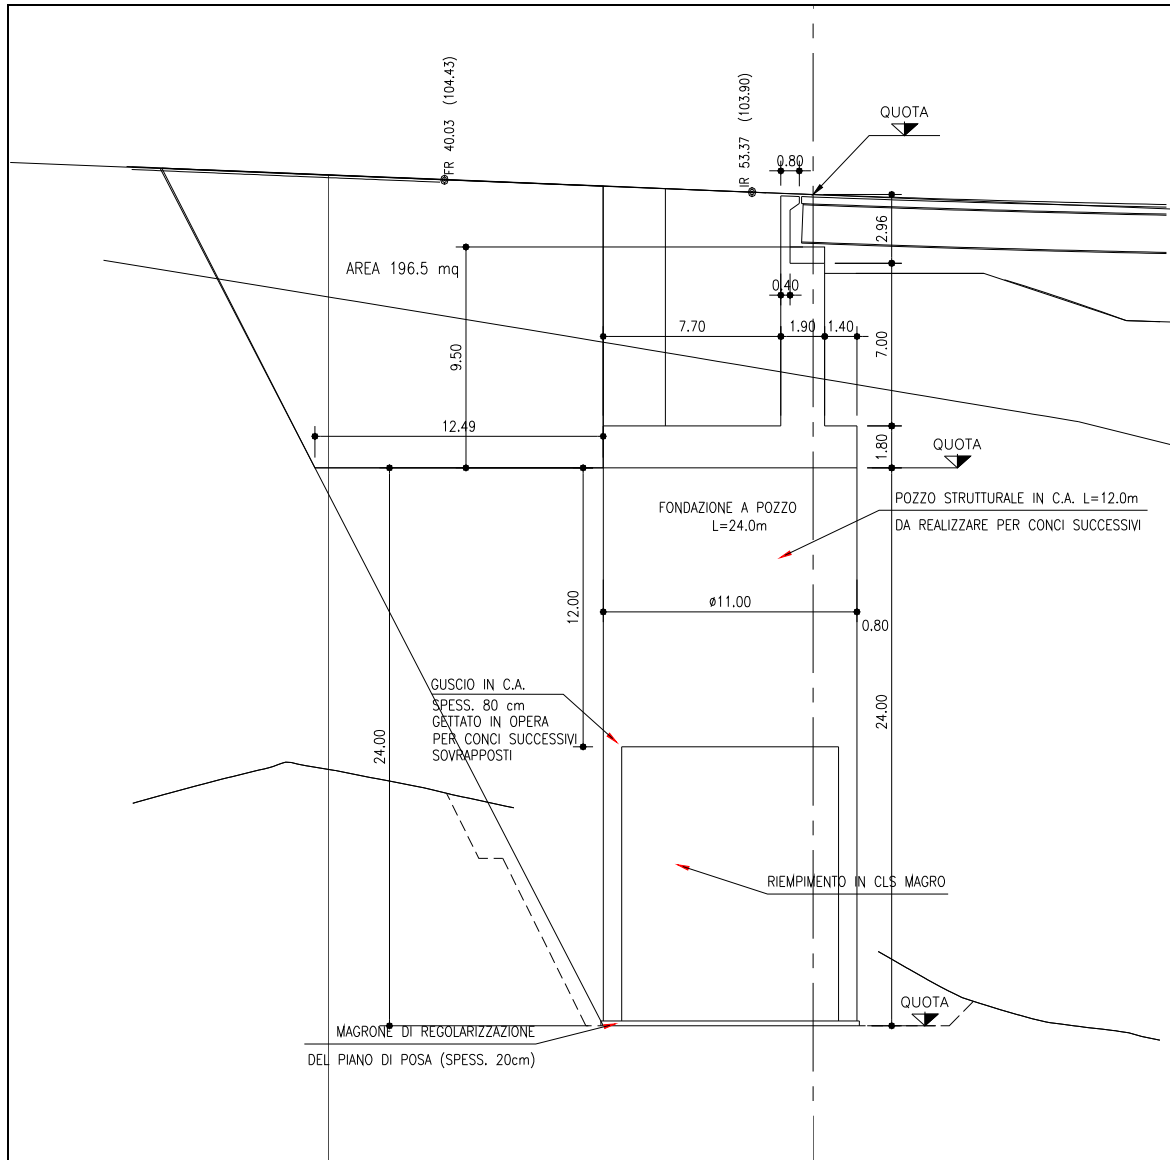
Schema geometrico del pozzo Spalla SP1
